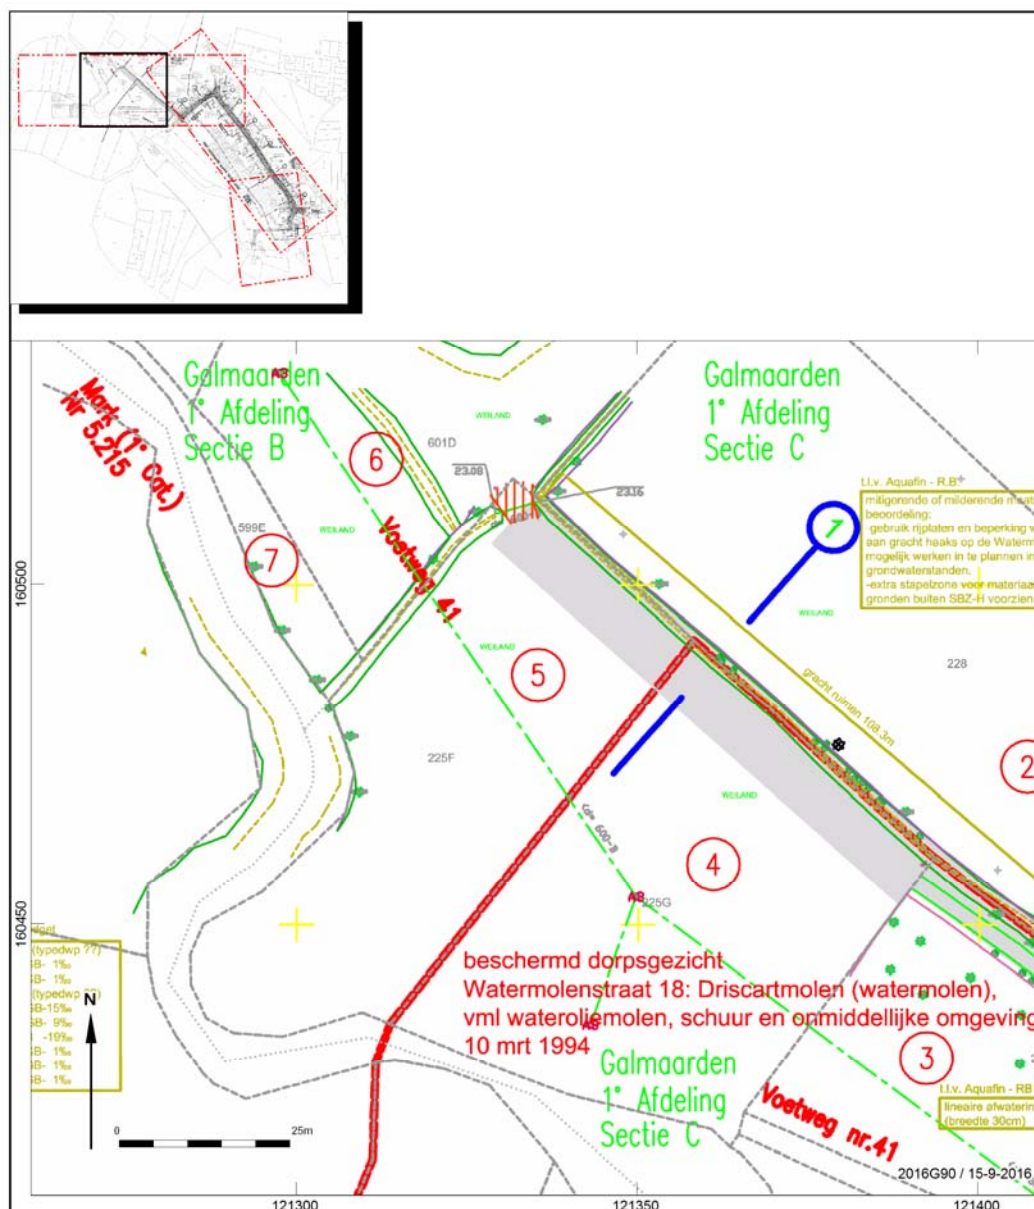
Detail van het overzicht van de geplande werken, uitsnede A.
